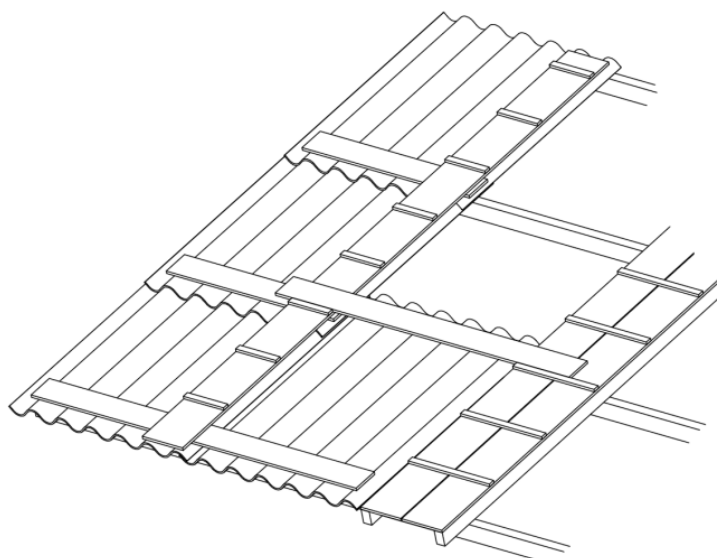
Esquema de montagem de estrutura para caminhar sobre telhas
